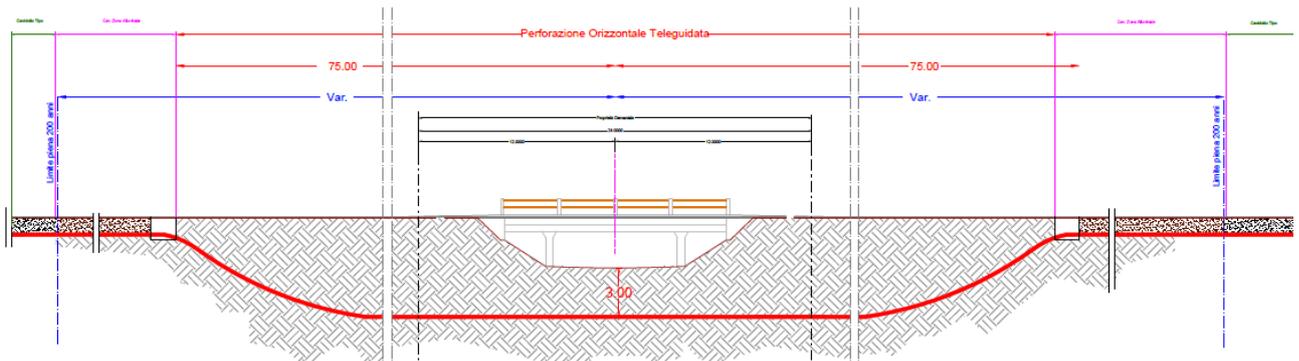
Particolare attraversamento canale La Pidocchiosa
